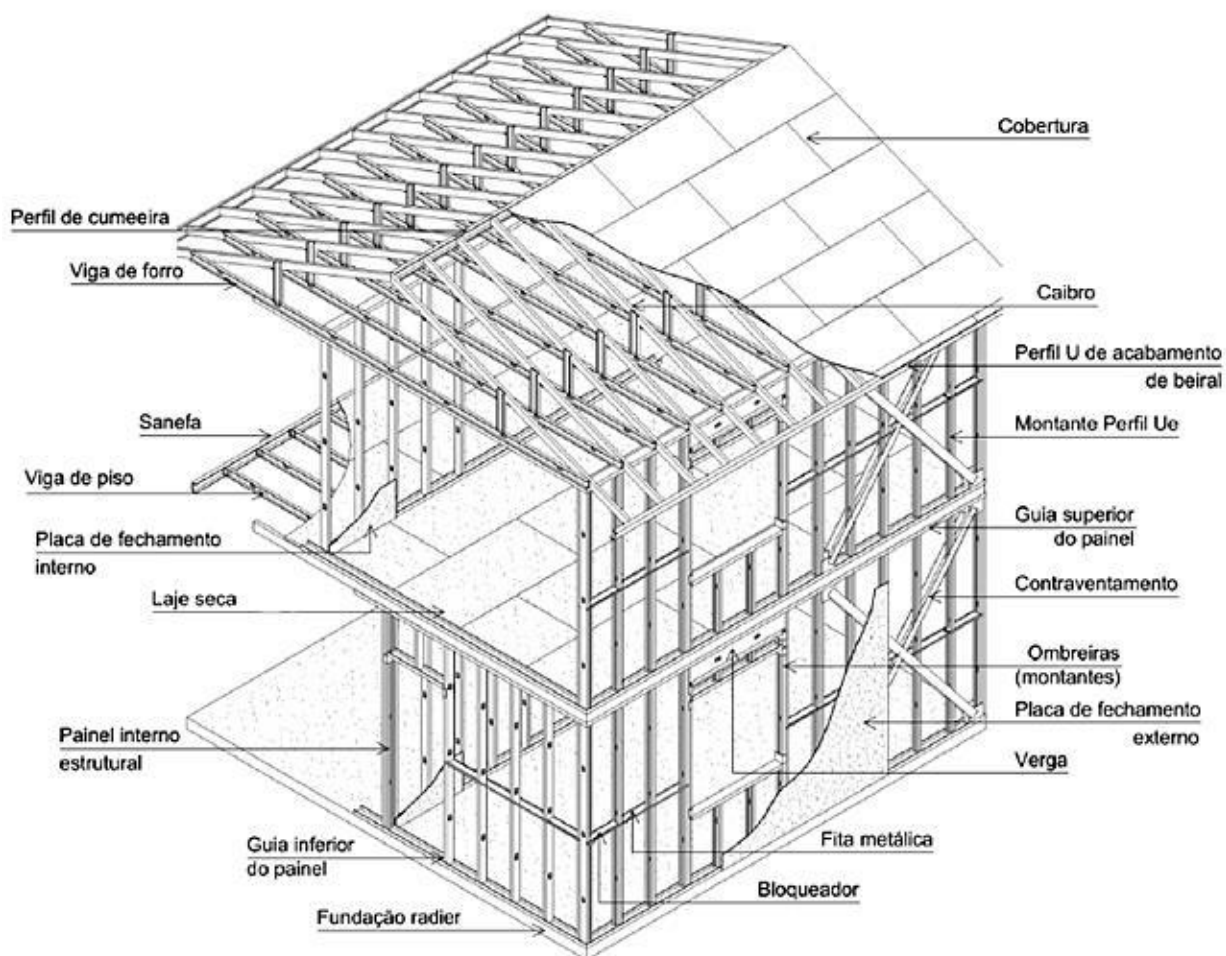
Esquema construtivo LSF (Portuguesa, 2014)
